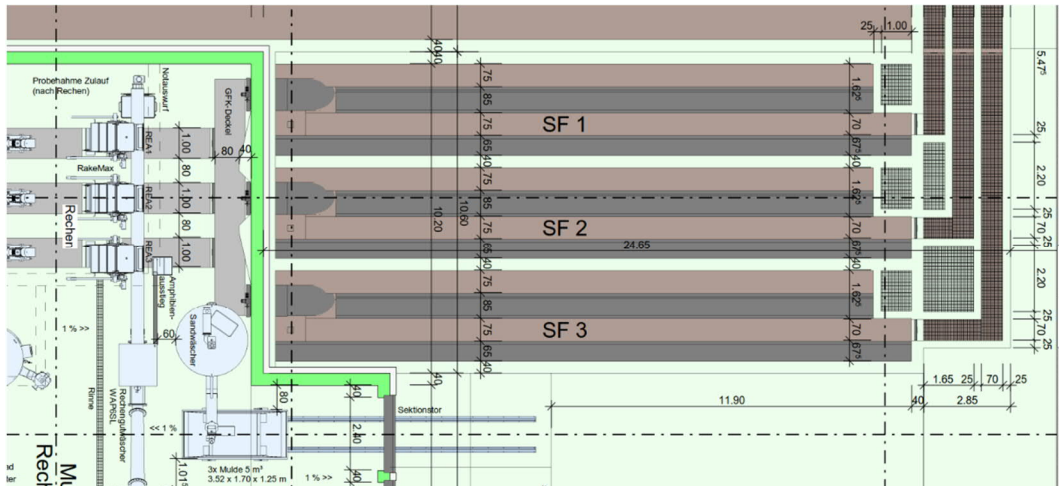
Grundriss der längsdurchströmten Sand- und Fettfänge
